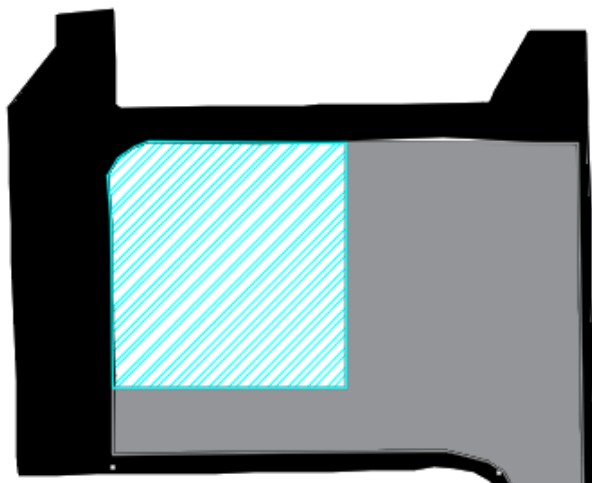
Croqui da área do pátio a ser convertida em pavimento rígido
